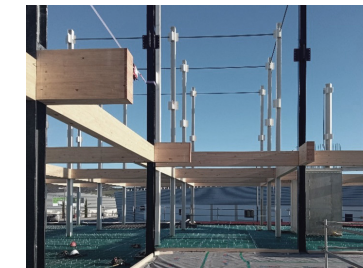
Imagen en obra. Hormigón, Acero, Madera.
